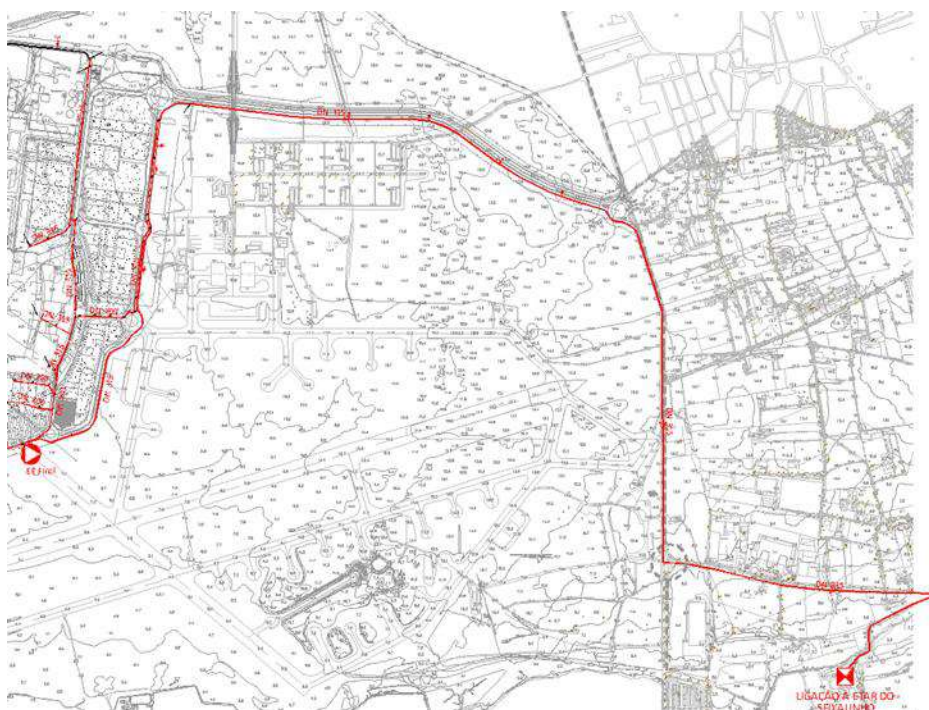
Esquema da solução proposta – conduta elevatória final e ligação à ETAR do Seixalinho
